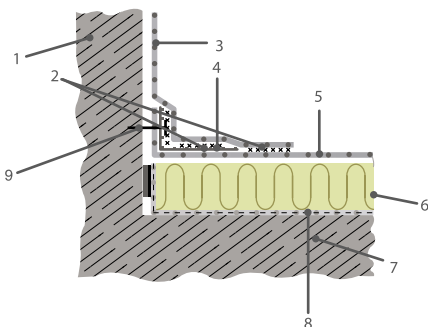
Примыкание системы ROCKROOF к вертикальной стене и водосточной воронке
